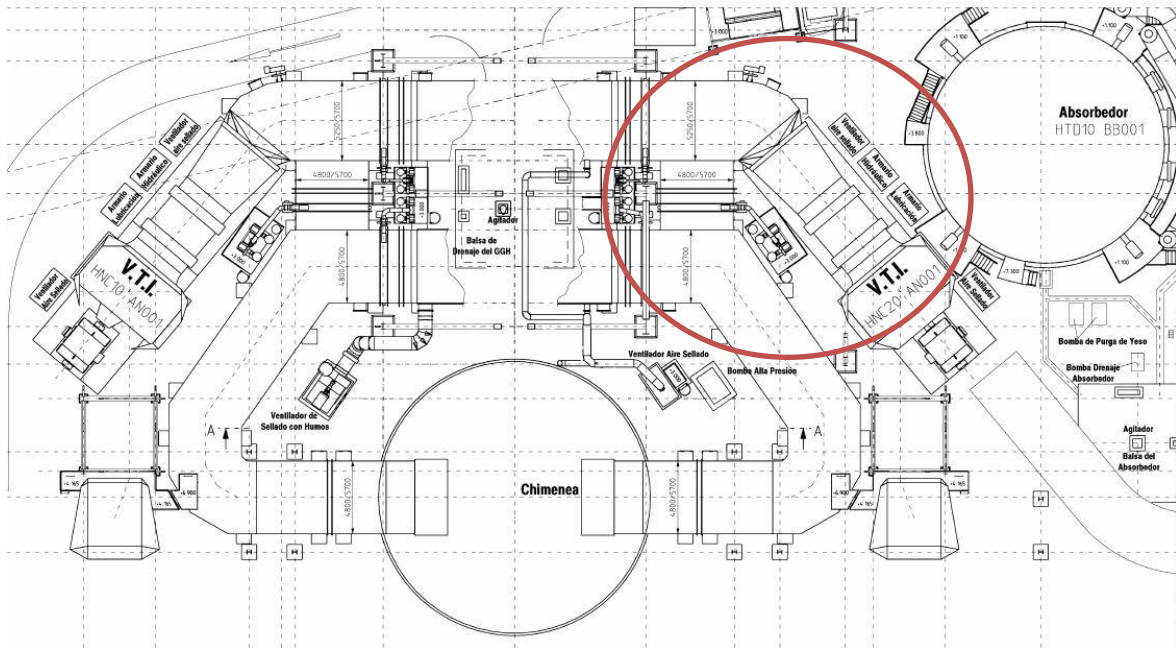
Disposición en planta de estructuras en zona de chimenea
